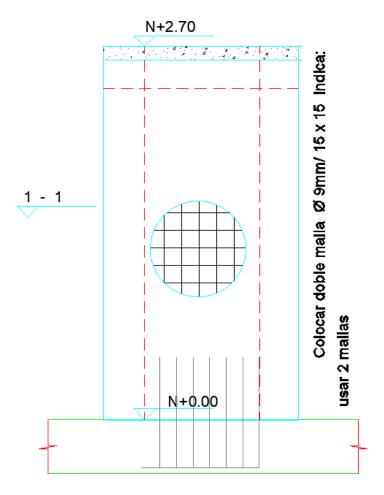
Indicación armadura muros estructurales. Fuente: Planos estructurales.
